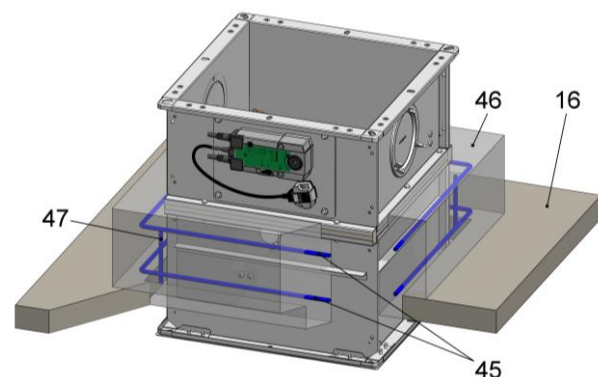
montaggio in soffitti massicci con zoccolo in calcestruzzo
